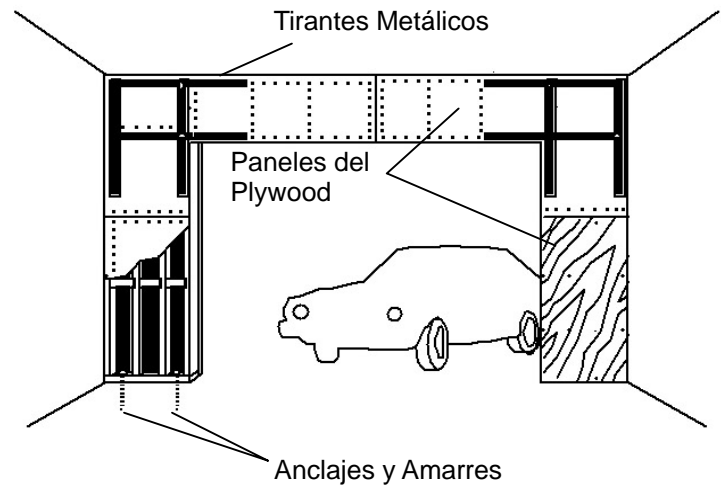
Refuerzo Adicional. Configuración de la casa donde no hay una pared alineada al garage. Un refuerzo adicional sería apropiado en esta situación.
